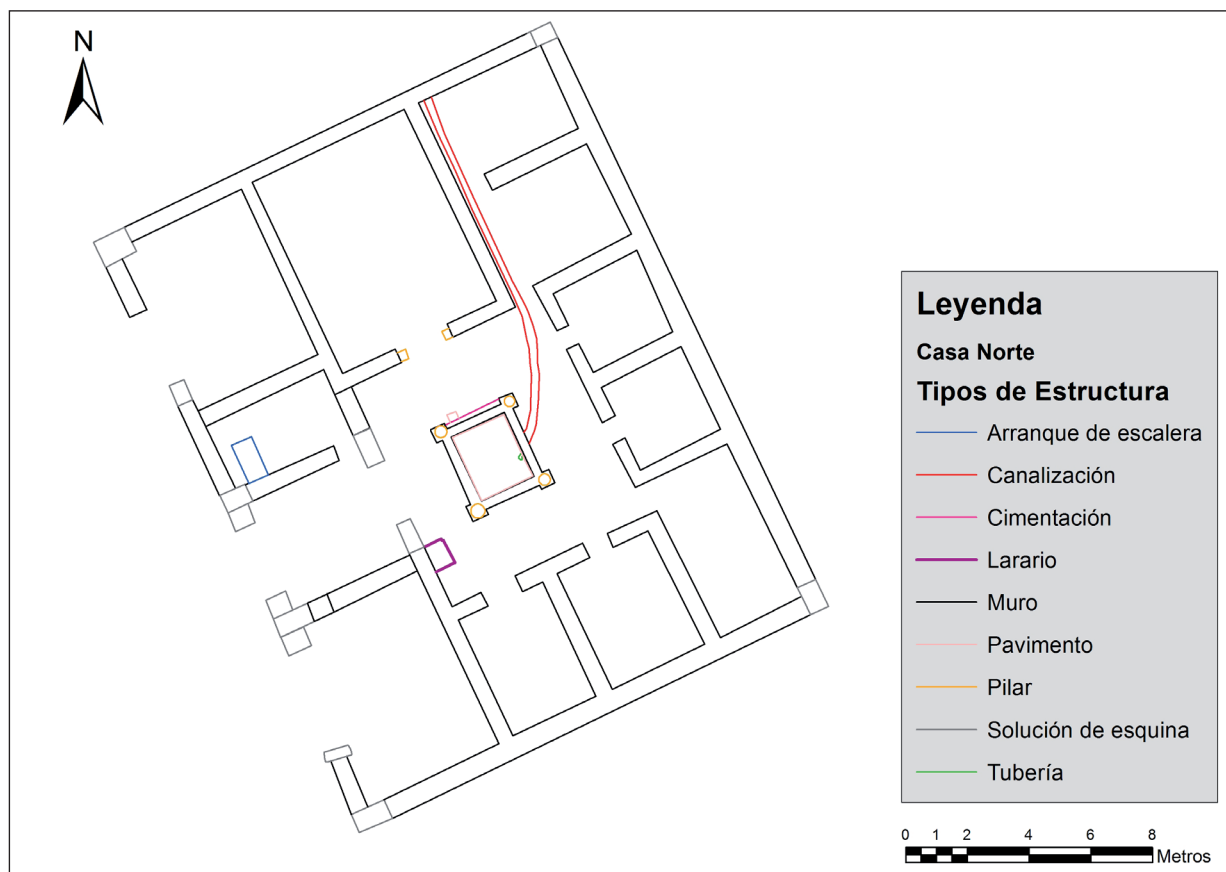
Planimetría que muestra los tipos de estructuras documentadas en la Casa Norte de Arucci (Grupo PAI-HUM132, Vrbanitas).
